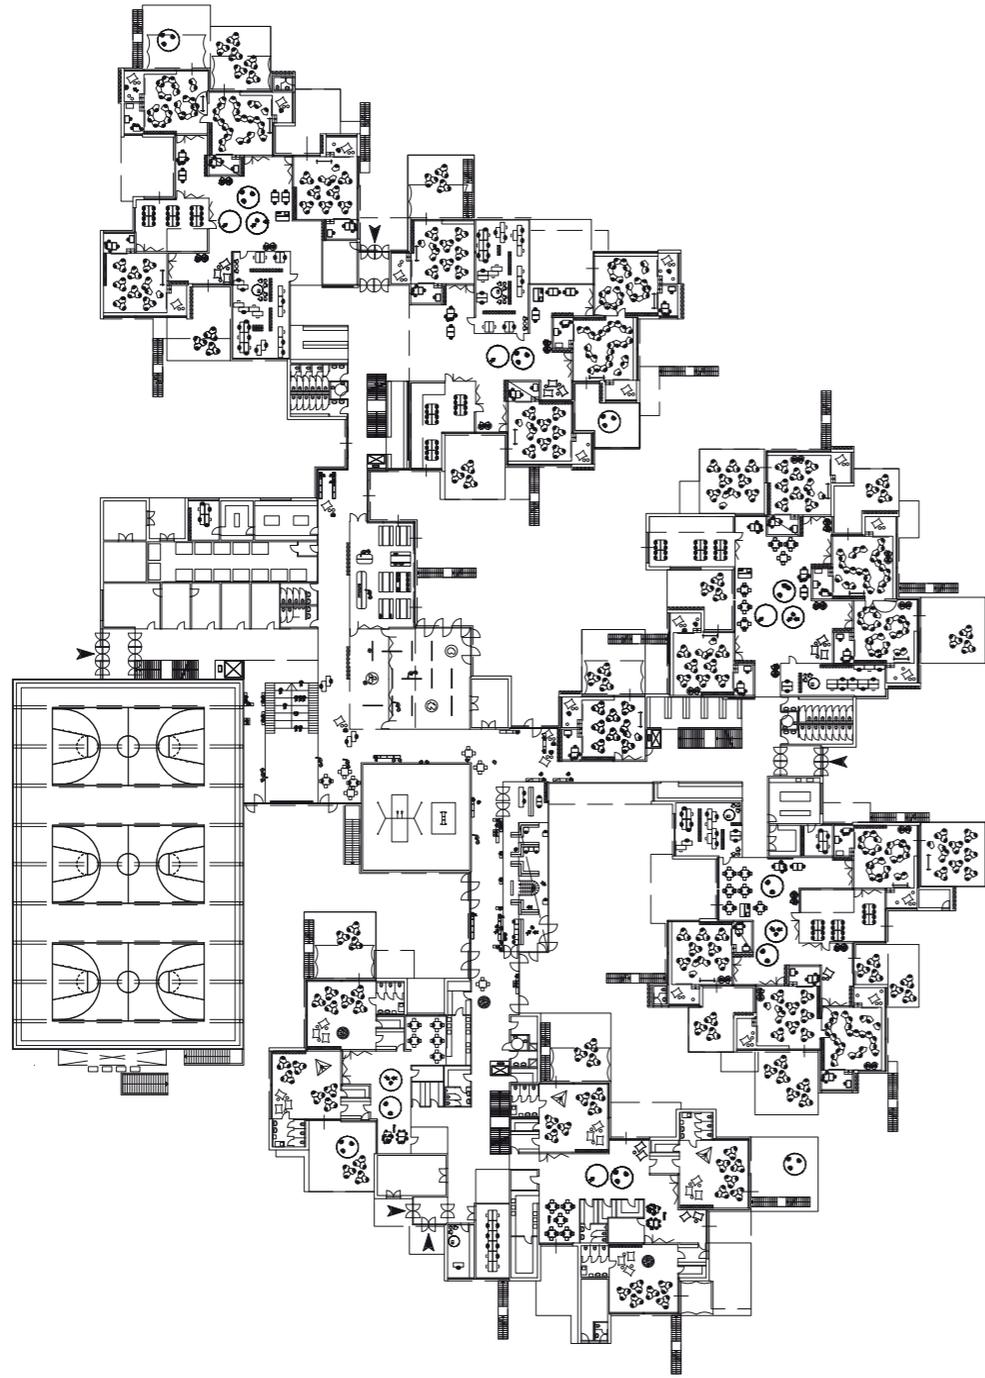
Grundriss Erdgeschoss, o.M.
